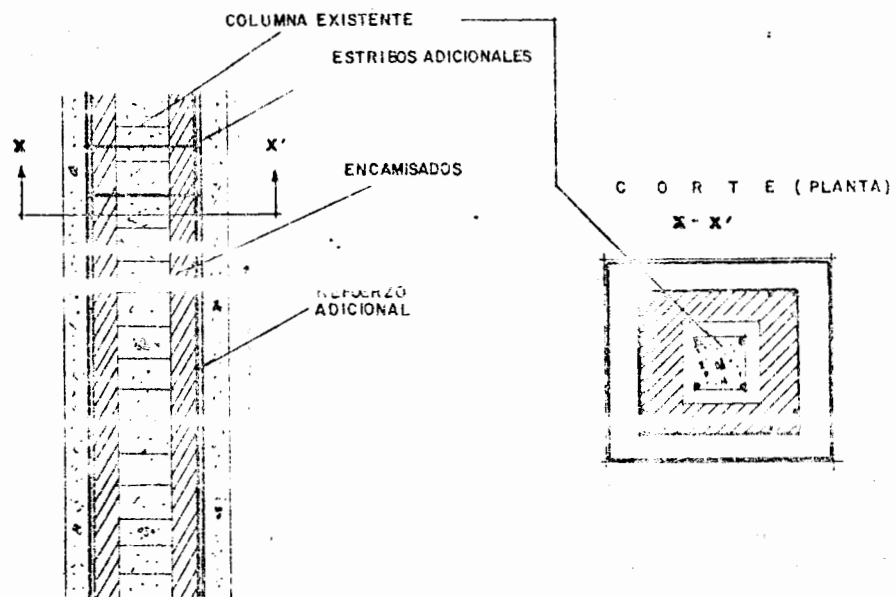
REPRESENTA DE UN ENCAMISADO DE COLUMNA CON CONCRETO REFORZADO.
